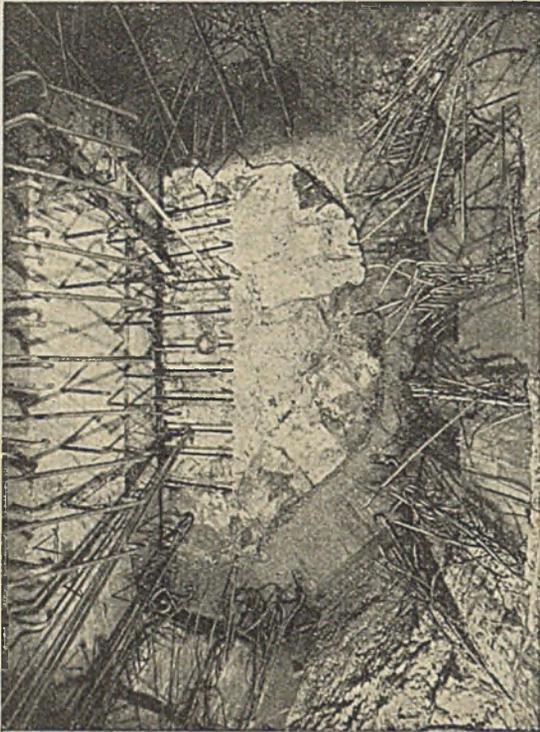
Baustelle der Schemelhälfte unter dem gotischen Turmmauerwerk mit den aus den fertigen Teilen hervorragenden Bewehrungsseisen, von unten gesehen.
